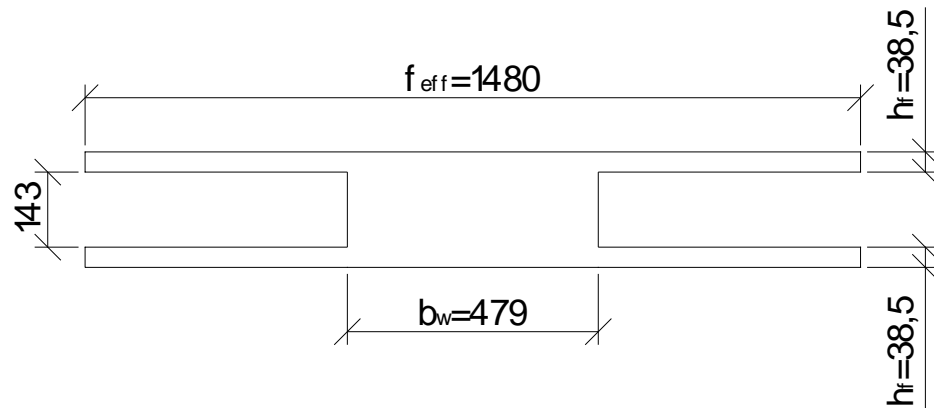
Приведений переріз багатопустотної плити до двотаврового.
